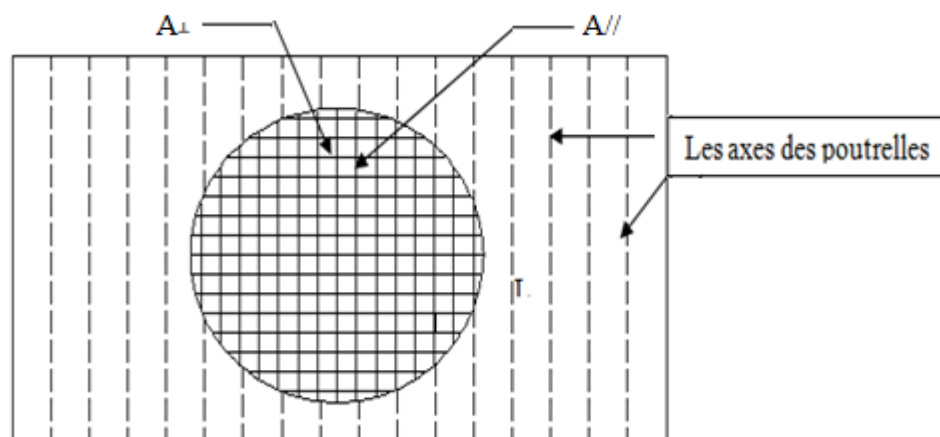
Schéma de Ferrailage de la dalle de compression
